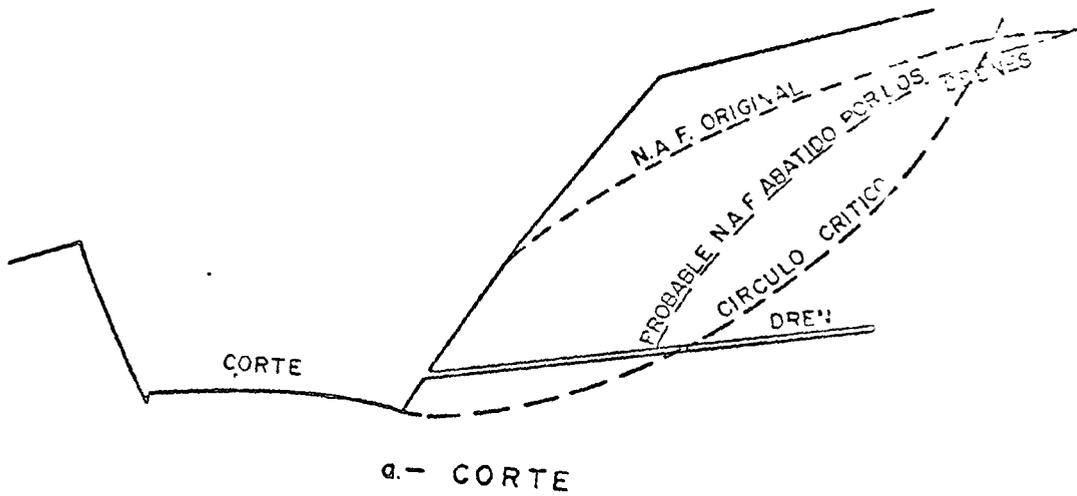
Croquis de la disposición de drenes transversales de penetración.
